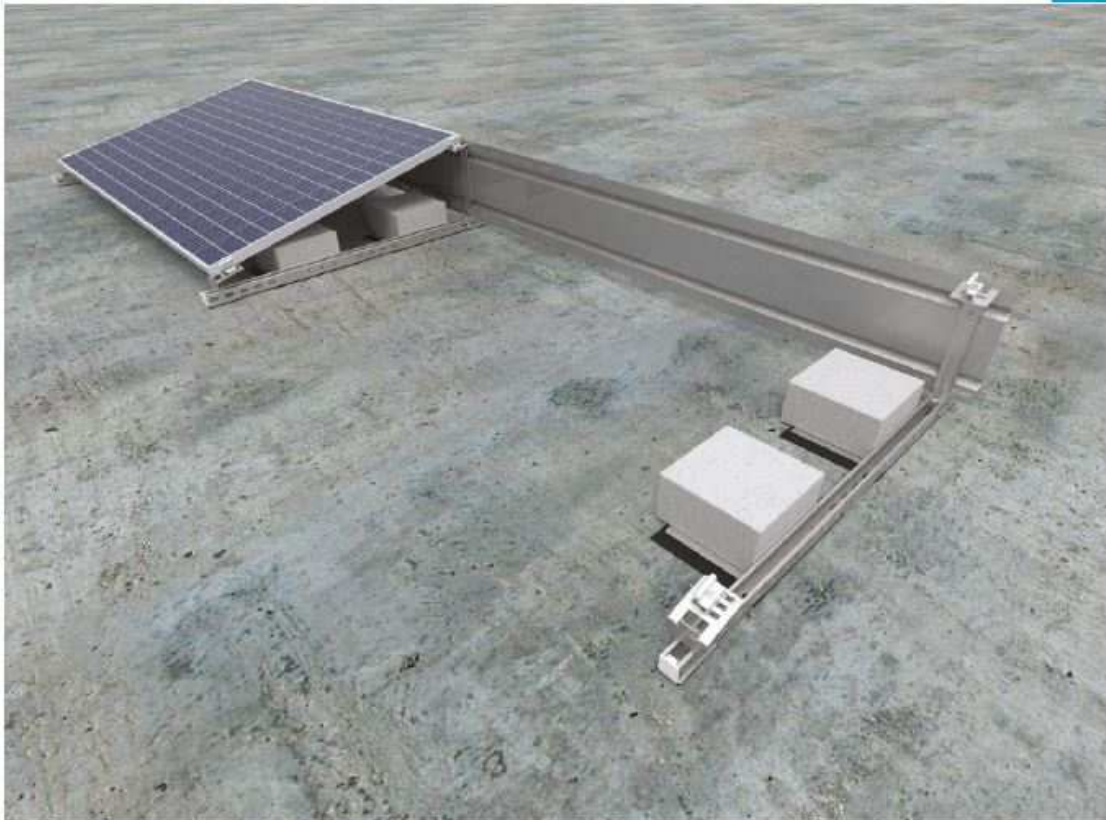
Przykładowe konstrukcja wsporcza zgrzewana (<https://www.baks.com.pl/>)
